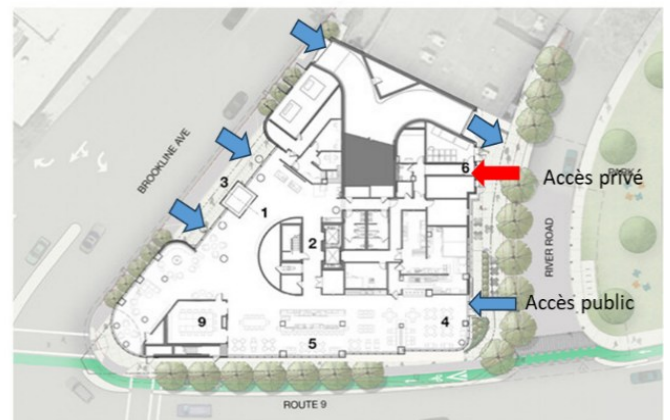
Plan de rdc de l'hôtel Hilton Garden.
